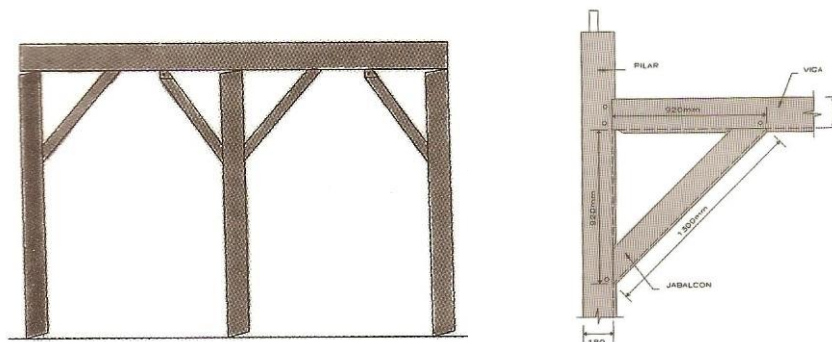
Pórtico e Respectivo pormenor [2]
